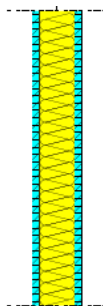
Pormenor da parede interior – Par\_Int\_1.
